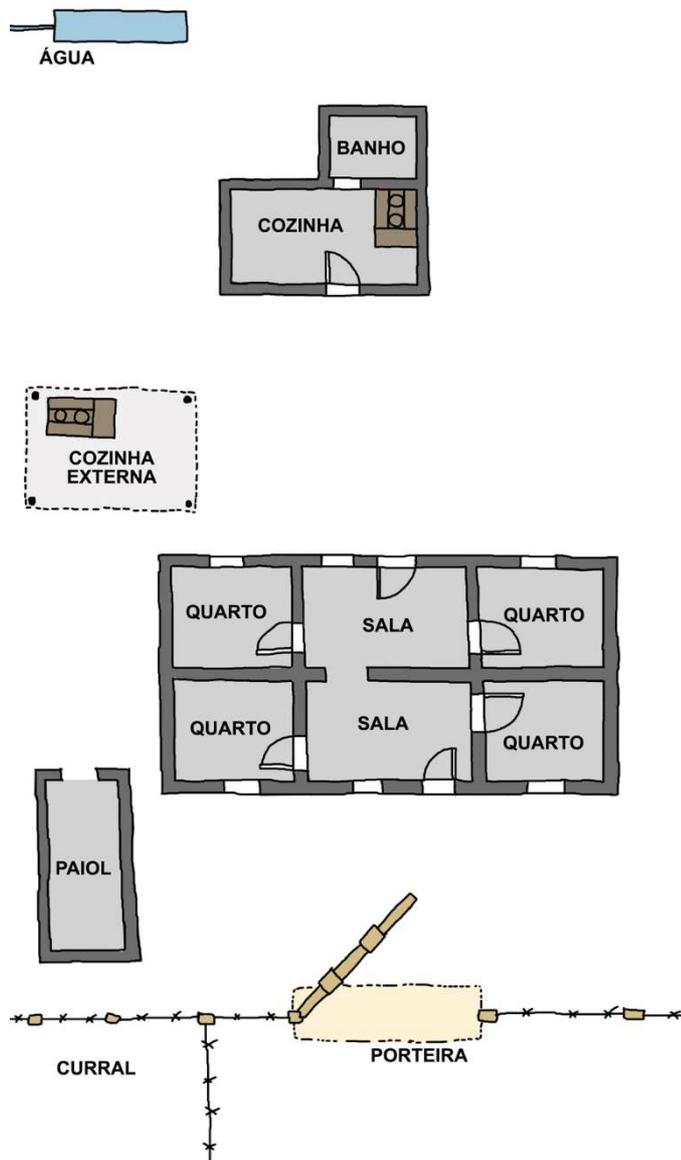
Planta esquemática da casa de Nelson e dona Marta.
